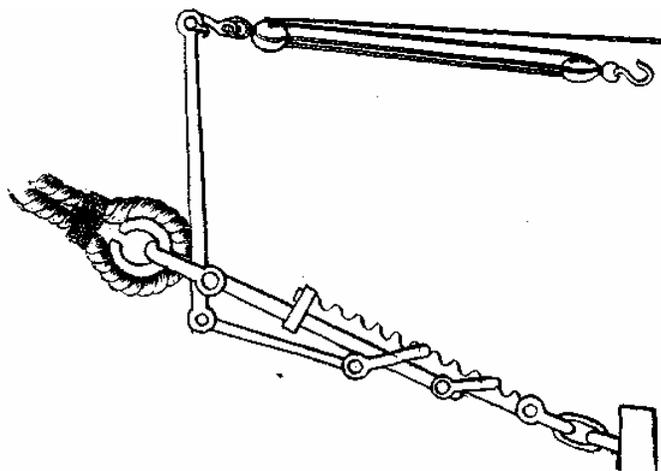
Натяжное устройство с «зубчатой рейкой» и рычагом с талиями для обтягивания вант.
